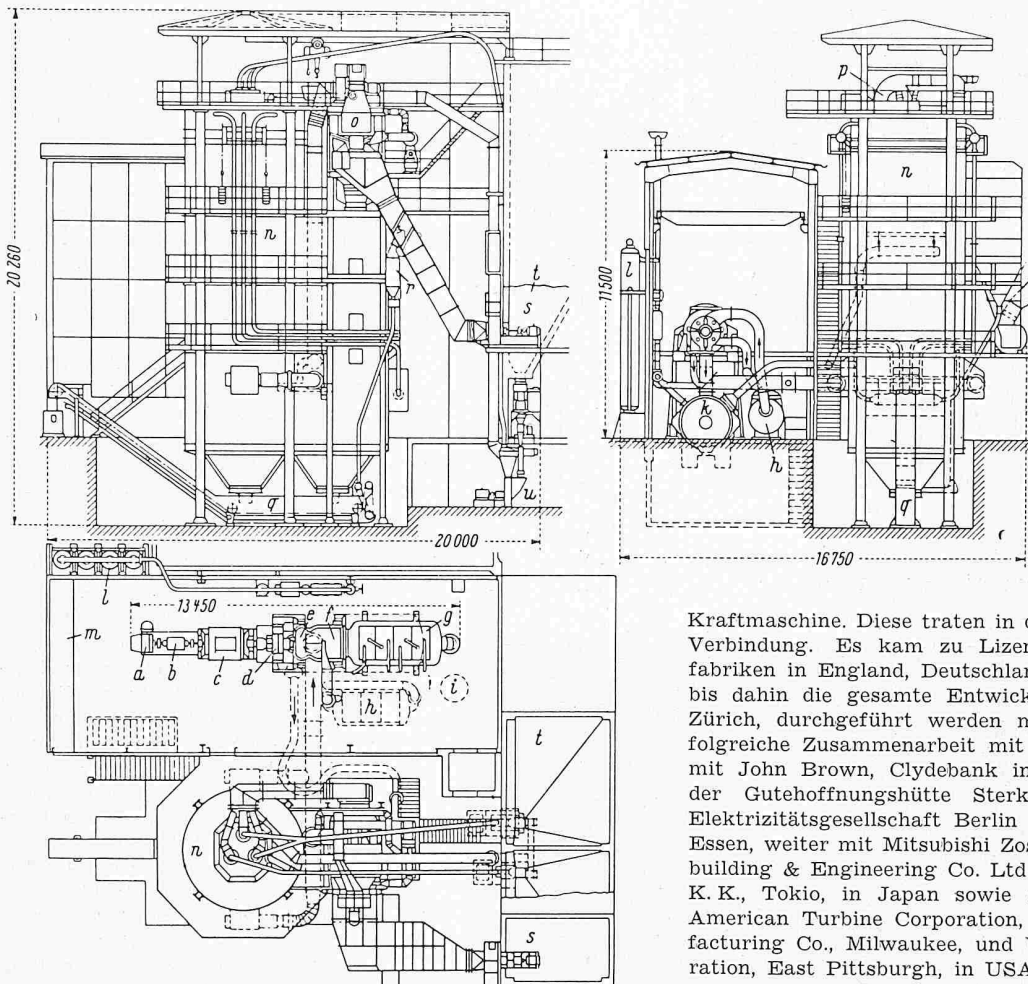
Dispositionsplan der Anlage Ravensburg, M 1:250
